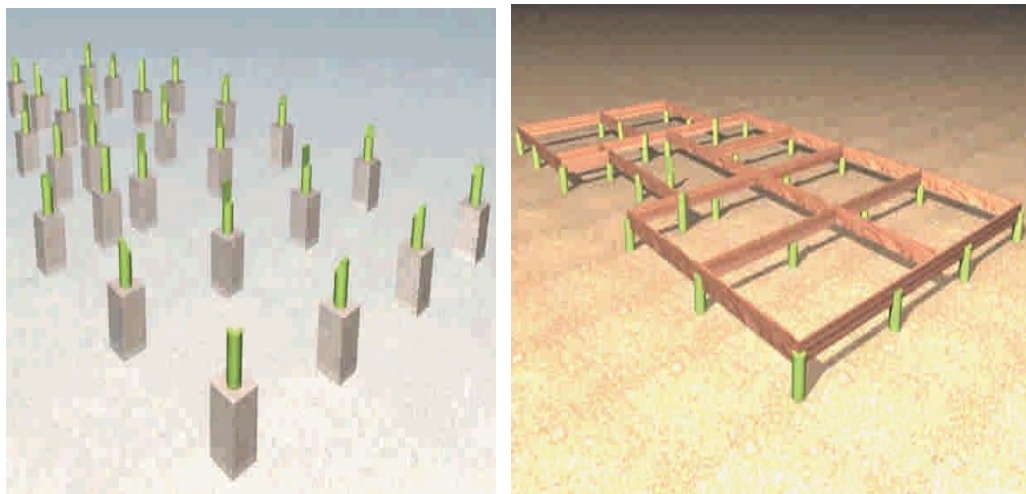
Pilas de concreto con pilotes de madera formando la base del piso.
